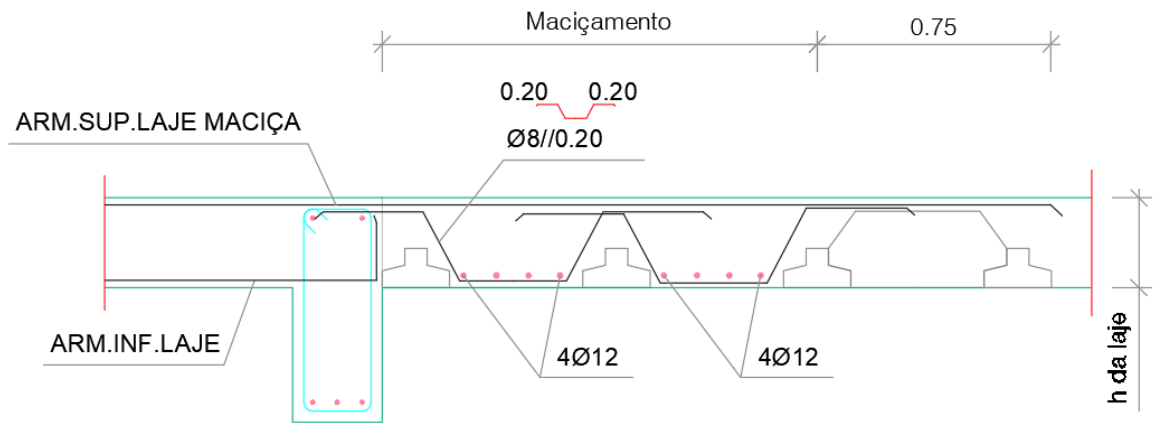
Pormenor tipo de maciçamento de lajes aligeiradas (Projeto de estruturas).
